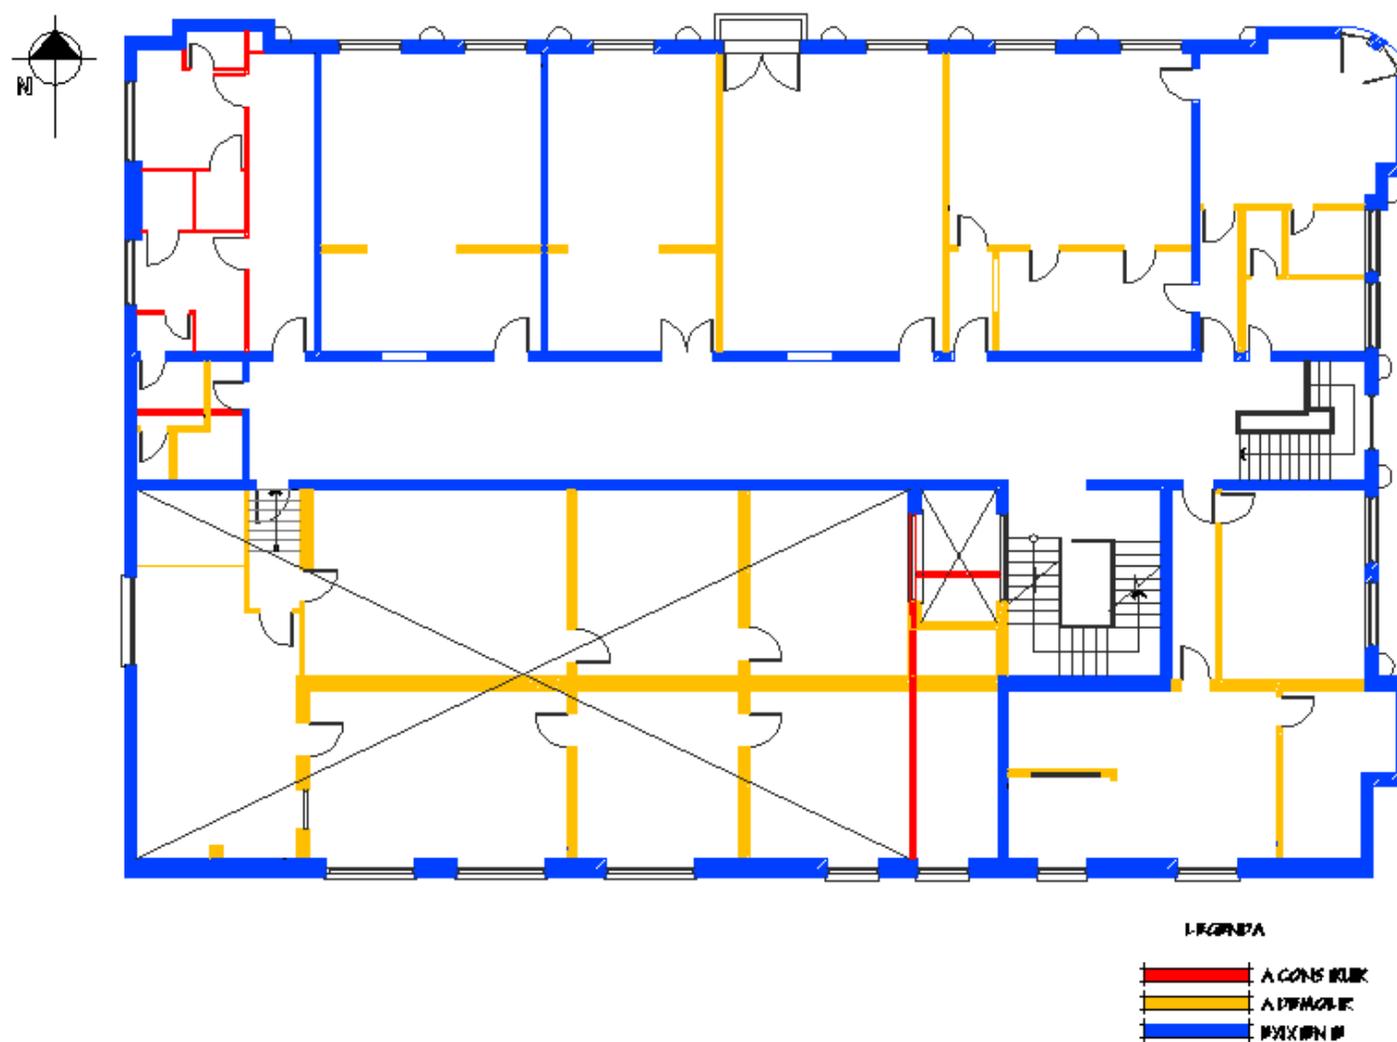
Planta Baixa Reforma Segundo Pavimento.
